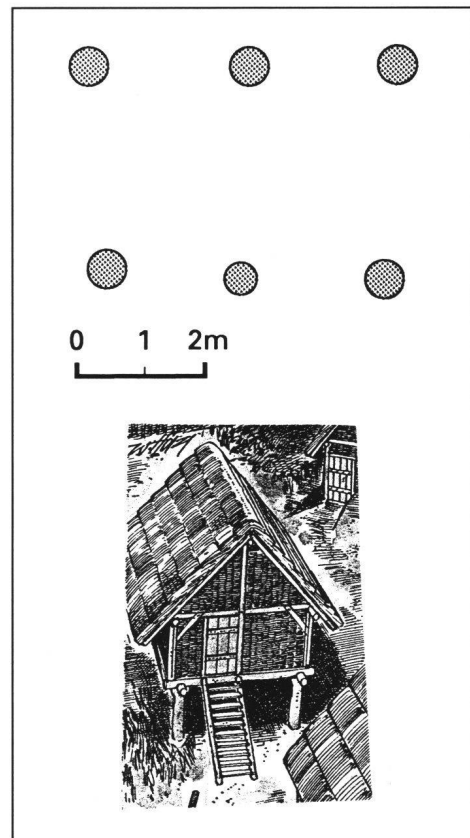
Speicher a beim Firstsäulenhaus A, im Grundriss (oben) und in einer Ansicht der Freilichtschau im Mattsee (unten).
